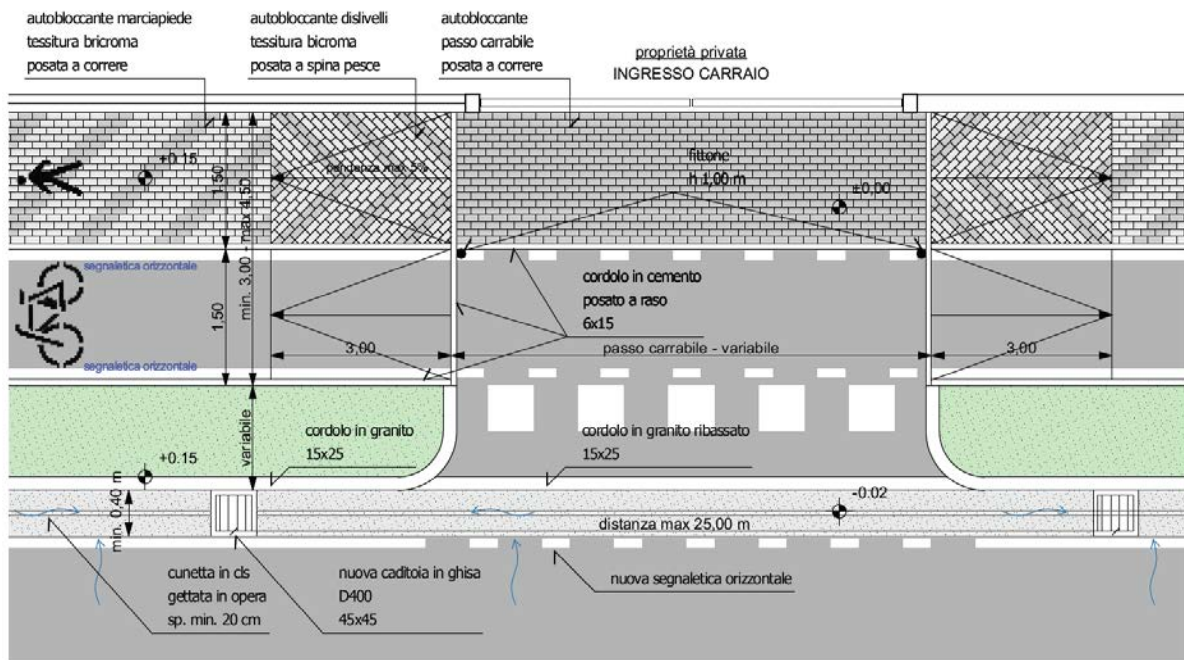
Estratto Tav. 6.9 – Dettagli
